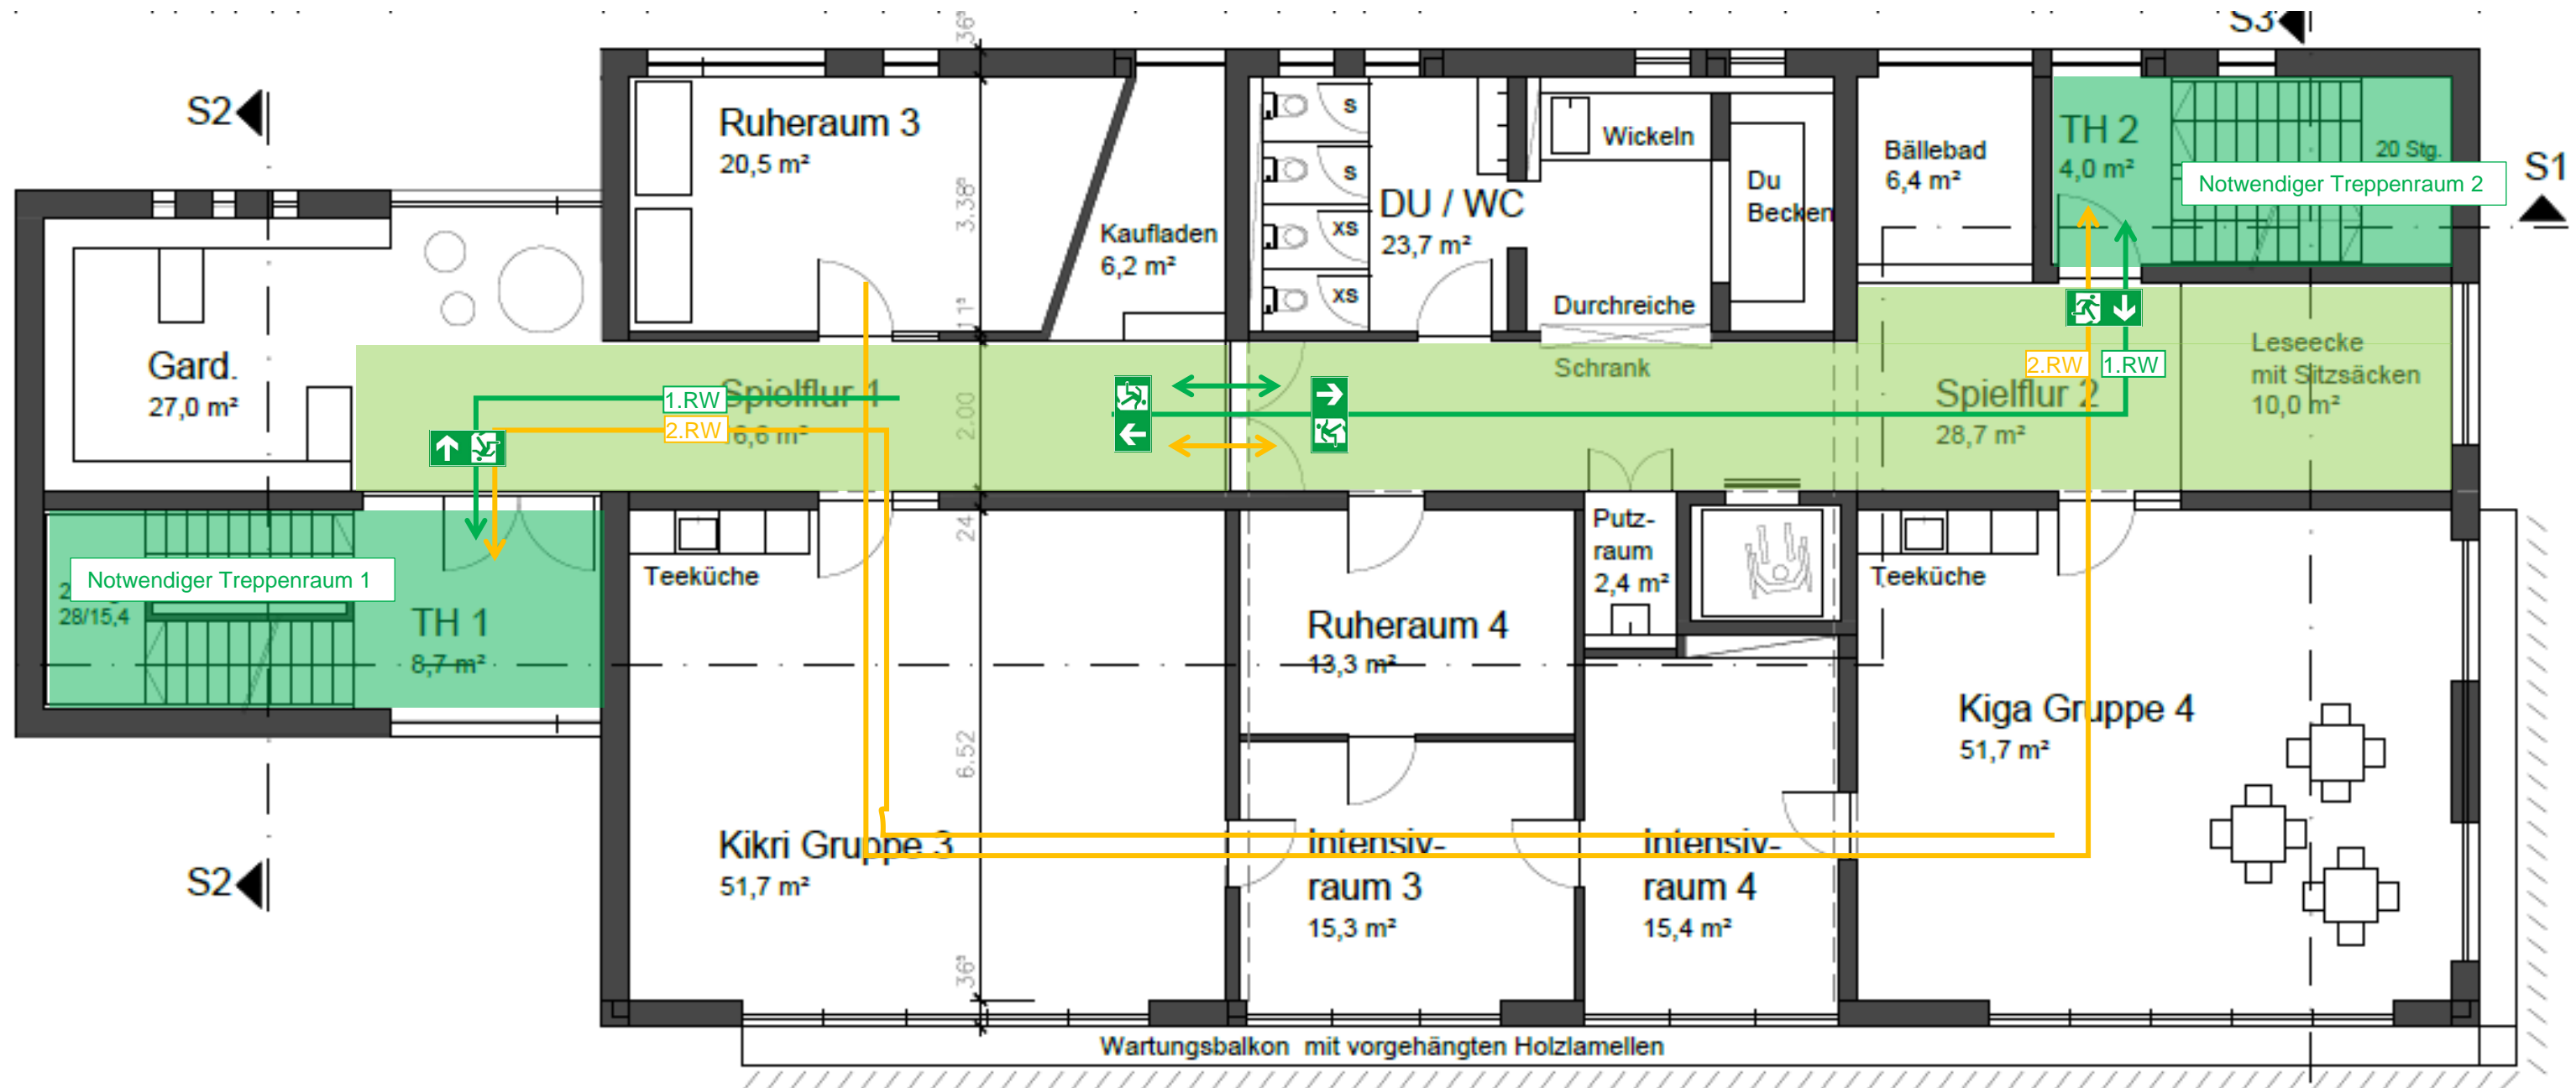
Grundriss 1. Obergeschoss
